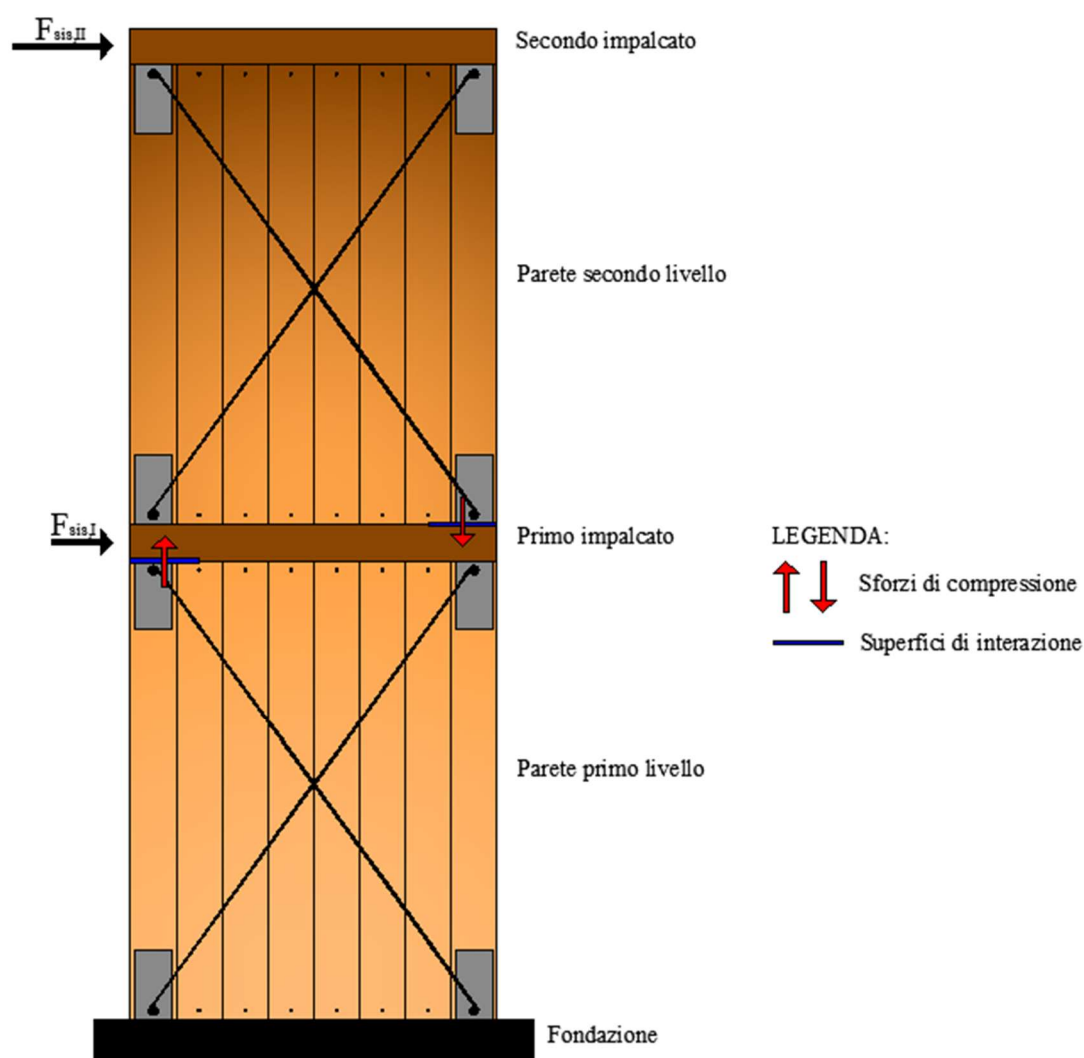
Porzione di parete POREPAN multipiano con plasticizzazione del solaio
